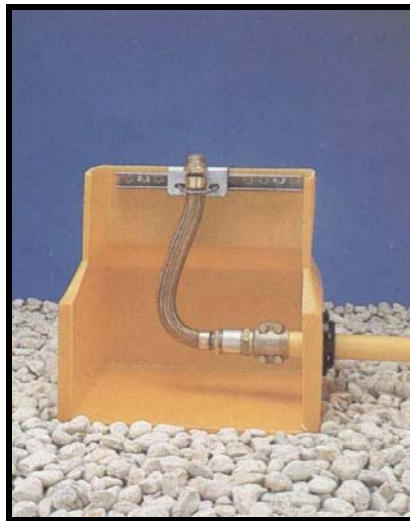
Câmara de contenção de vazamentos para bomba de abastecimento em corte
